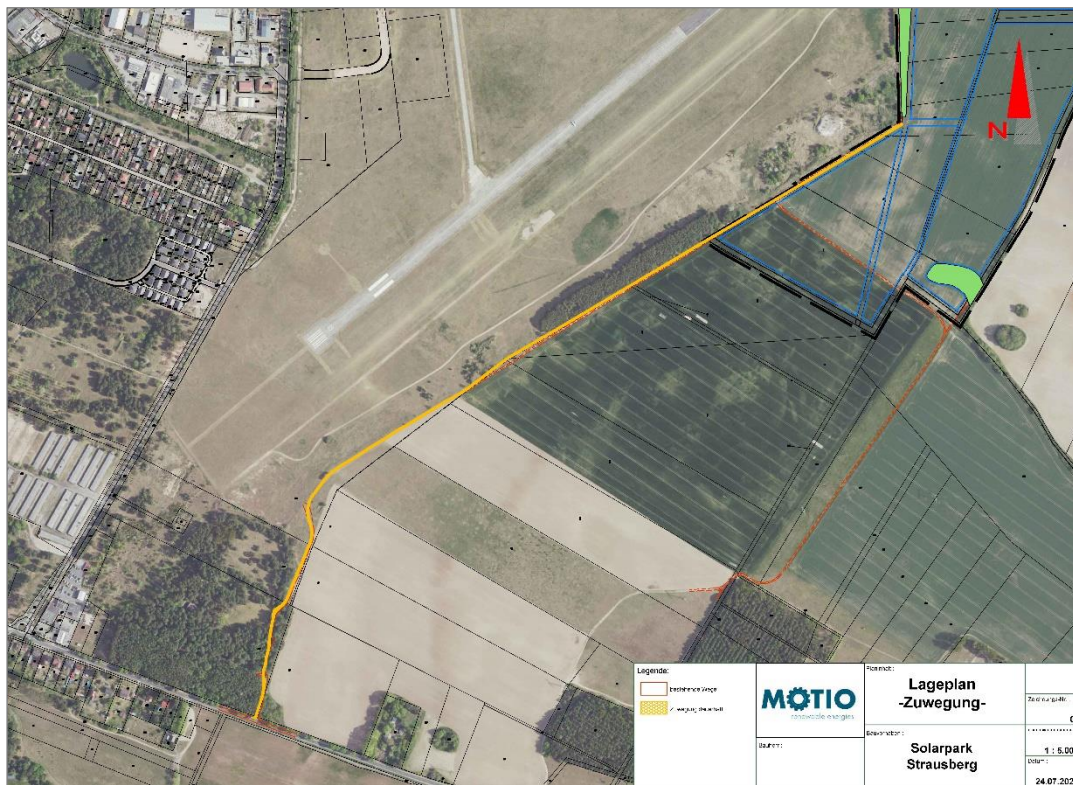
Lageplan der Zuwegung, Stand 24.07.2025
